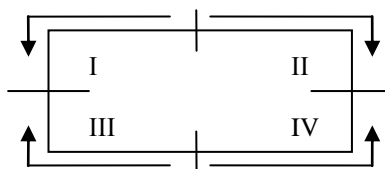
Схема разбивки здания на захватки при укладке фундаментных балок и стеновых панелей
